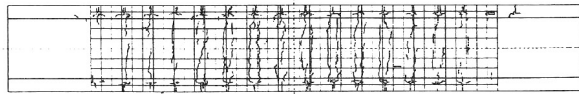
ひびわれ状況 (鉄筋応力度 137N/mm^2)
